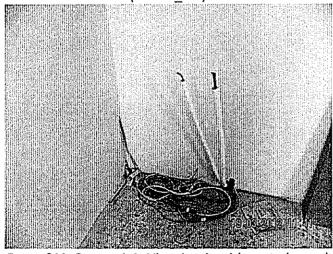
Stanza 1.1: Vista impianti (parete bagno)
